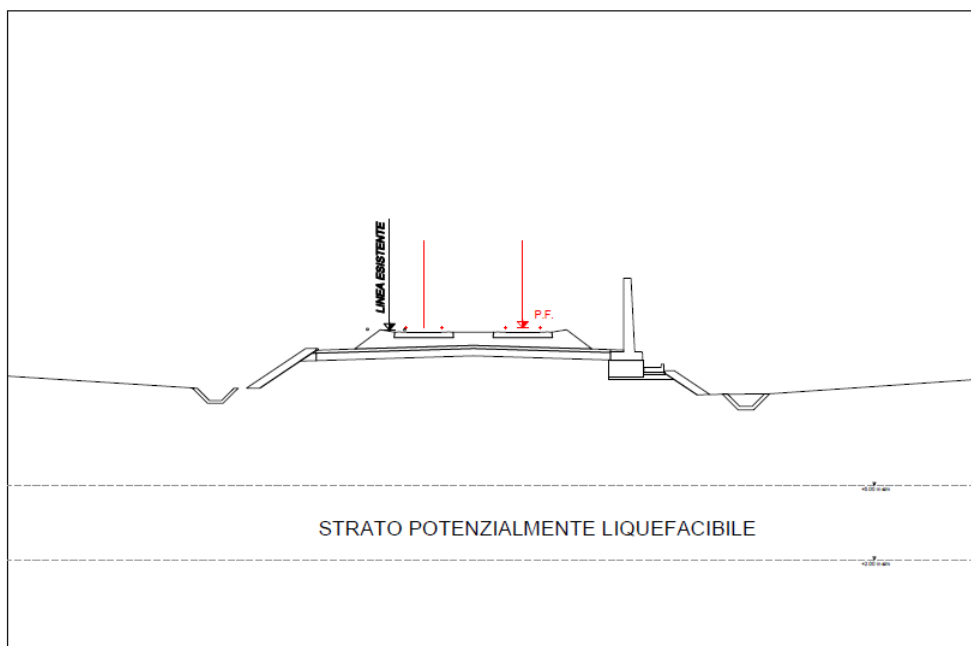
Sezione rilevato alla pk 2+700 su strato di terreno liquefacibile
